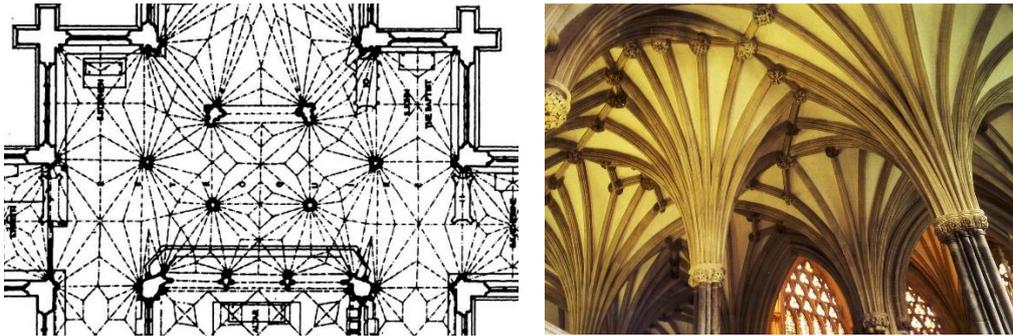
und 29 Wells, Kathedrale, Retrochor, Grundriss und Gewölbeformation
